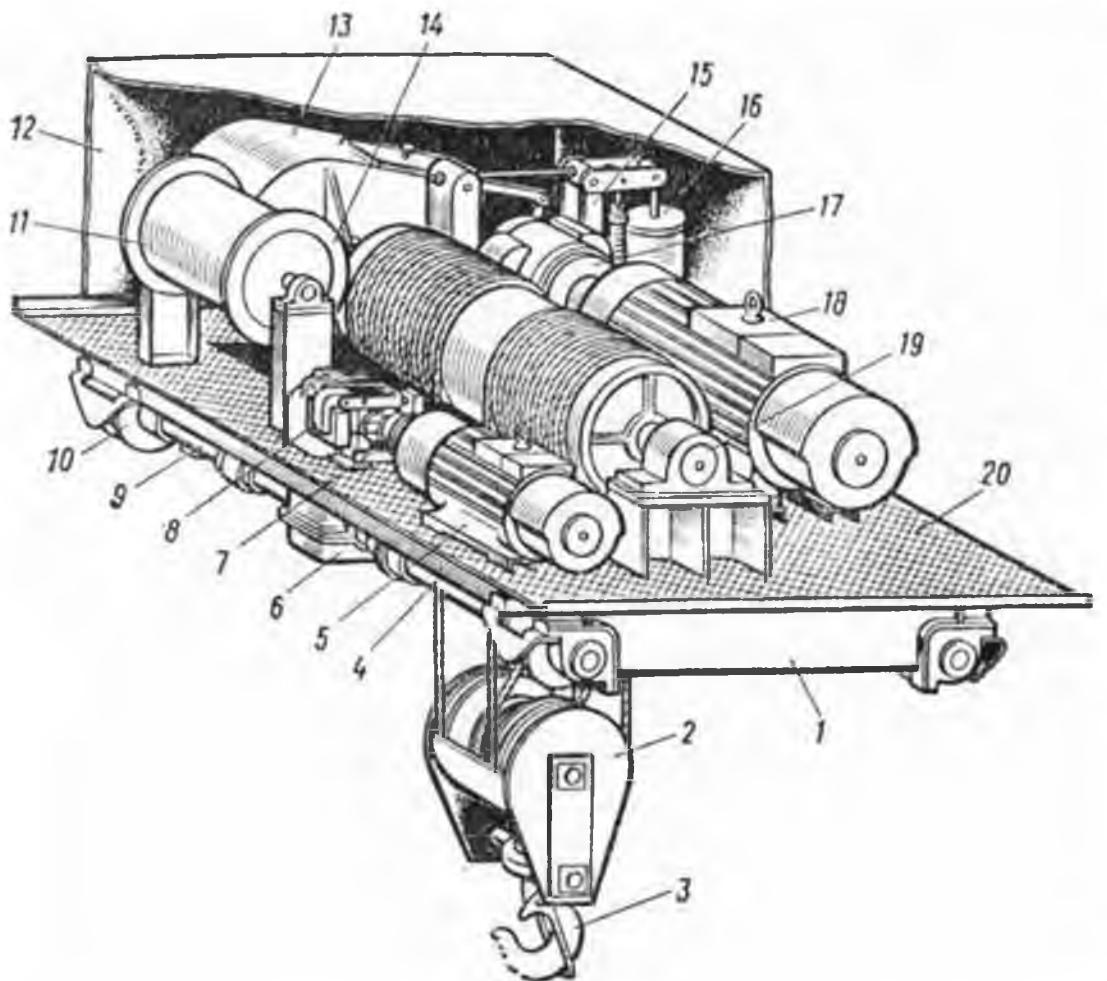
Вантажний візок крана КПБ-10М: 1 - рама; 2 - крюкова обойма; 3 - гак; 4 - ланцюгова муфта; 5 - електродвигун пересування; 6 - редуктор; 7.8 - гальмо; 9 - вісь ковзанок; 10 - каток; 11 - кабельний барабан; 12 - кожух; 13 - редуктор; 14 - вантажний барабан; 15 - гальмівний пристрій; 16 - гідроштовхачі; 17 - ланцюгова муфта; 18 - електродвигун підйому вантажу; 19 - підшипник вантажного барабана; 20 – поміст
